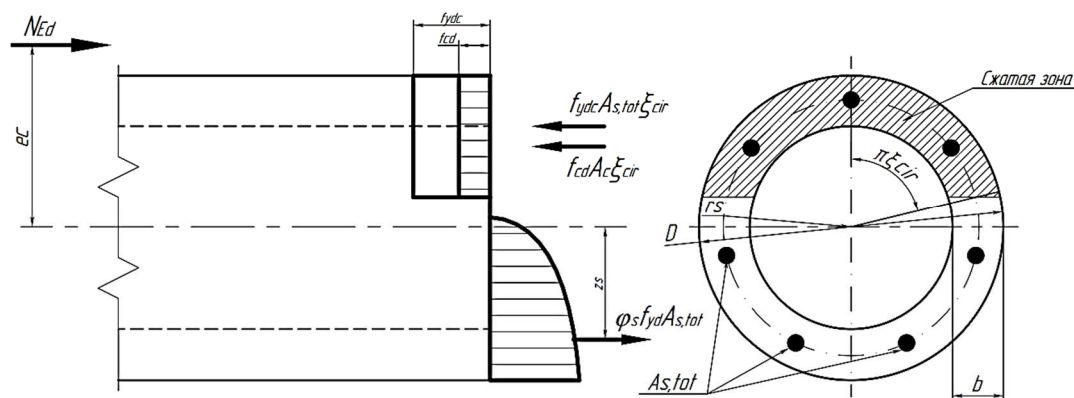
К расчету кольцевого сечения внецентренно сжатого железобетонного элемента [16; 17]
